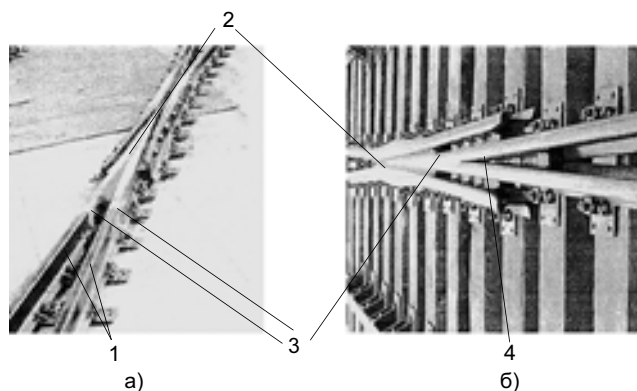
Крестовина с приваренными рельсовыми окончаниями: а — Дн 040; б — Дн 210; 1 — рельсовые окончания; 2 — сердечник крестовины; 3 — стыковой шов; 4 — сварное рельсовое окончание
